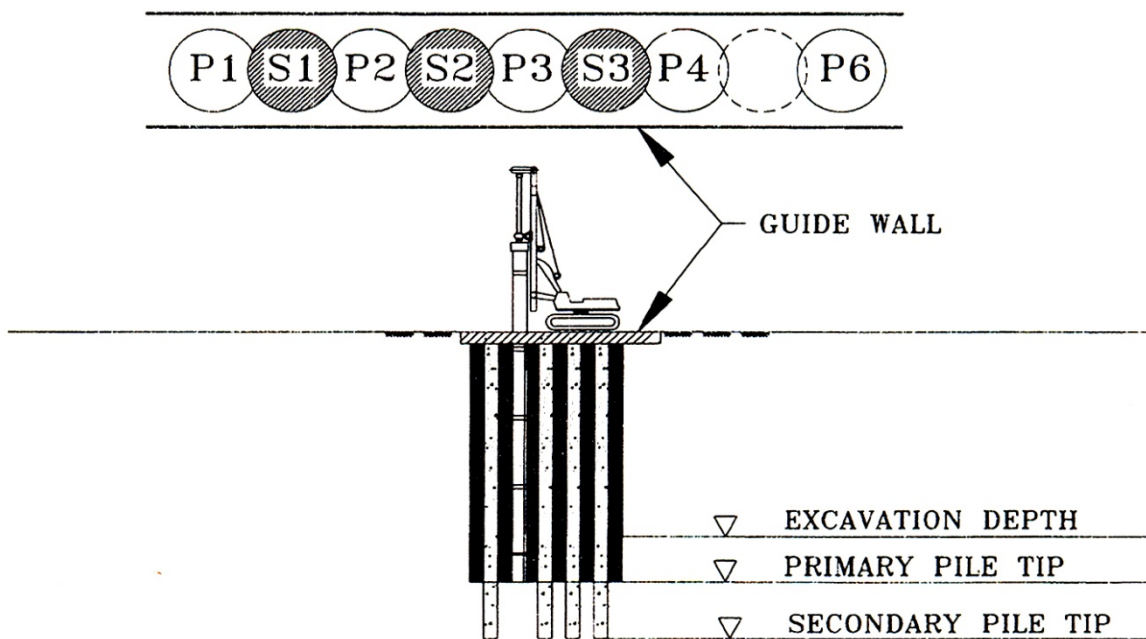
รูปแบบโครงสร้างกำแพงกันดินแบบ Secant Pile Wall
